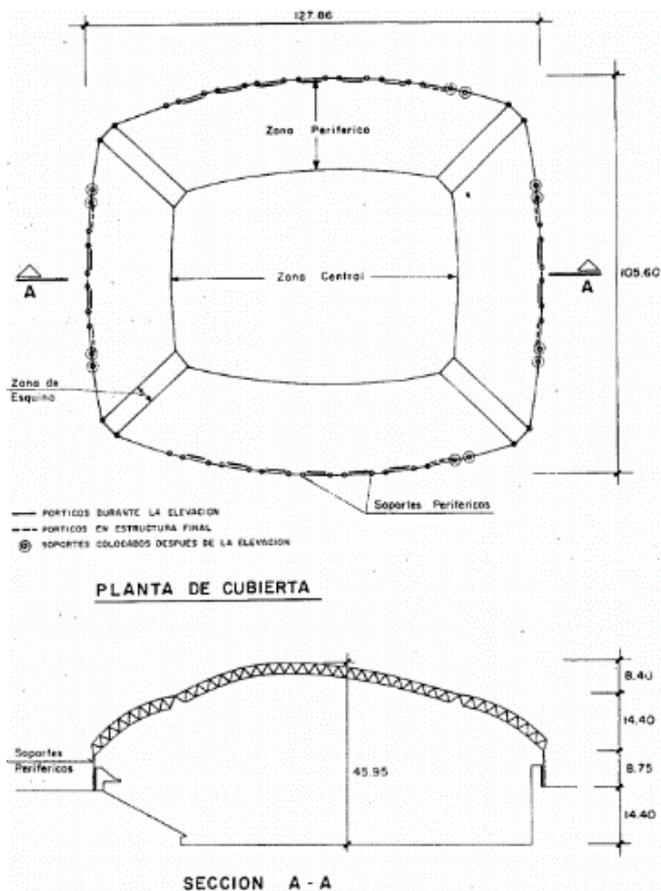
Geometría y dimensiones de la cubierta principal.
